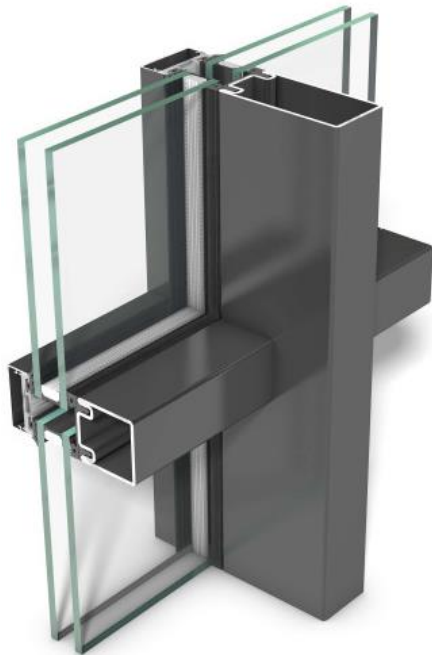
Pfosten-Riegel Fassade und Elementfassade
